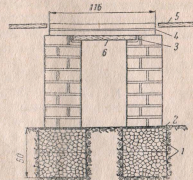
Фундамент из двух столбиков в нормальном песчаном грунте:
